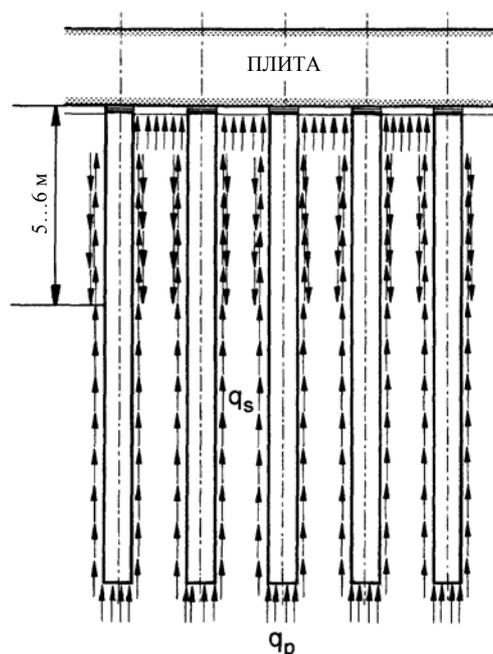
Схема передачи нагрузки с плитно-свайного фундамента на грунт
